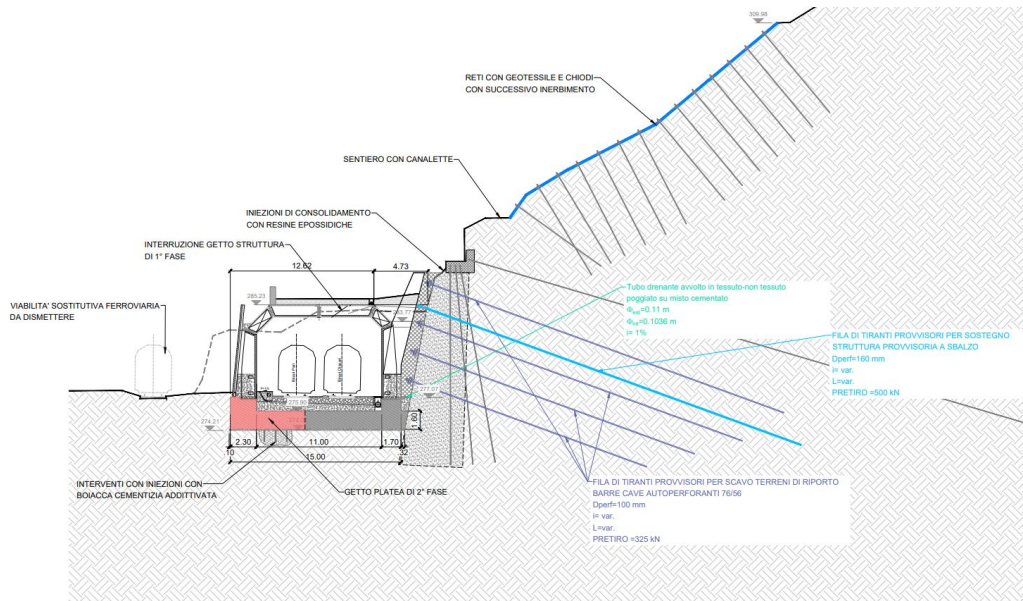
Stralcio di una sezione di intervento sul muro da consolidare lato Ovada.
